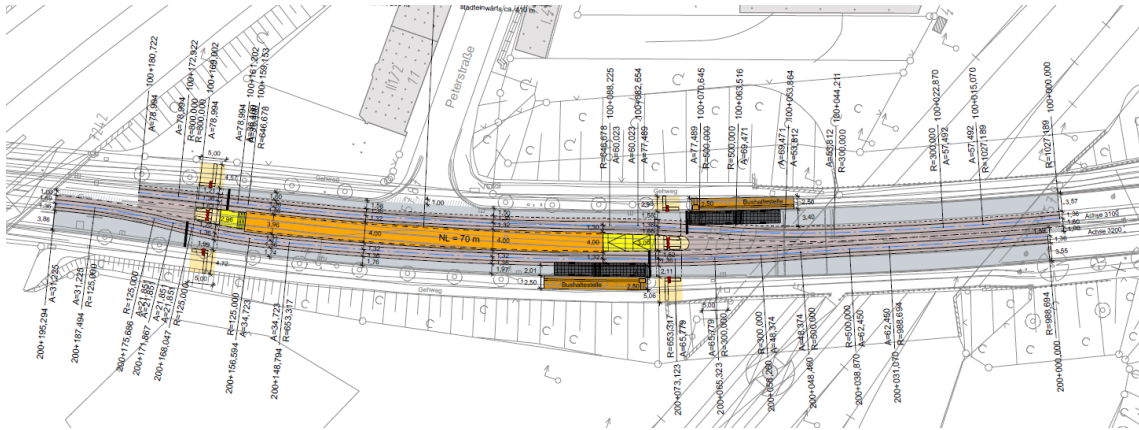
Ausschnitt aus dem Lageplan Variante 3
